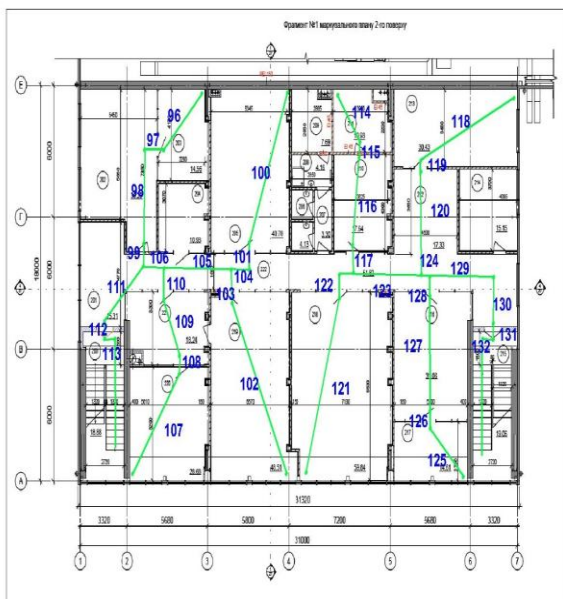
Схема евакуації людей з 2-го та 3-го поверху будівлі
